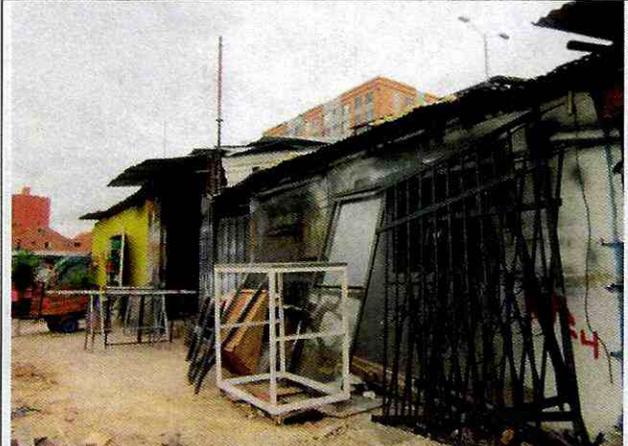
Fachada sobre la Diagonal 182 en buen estado.
